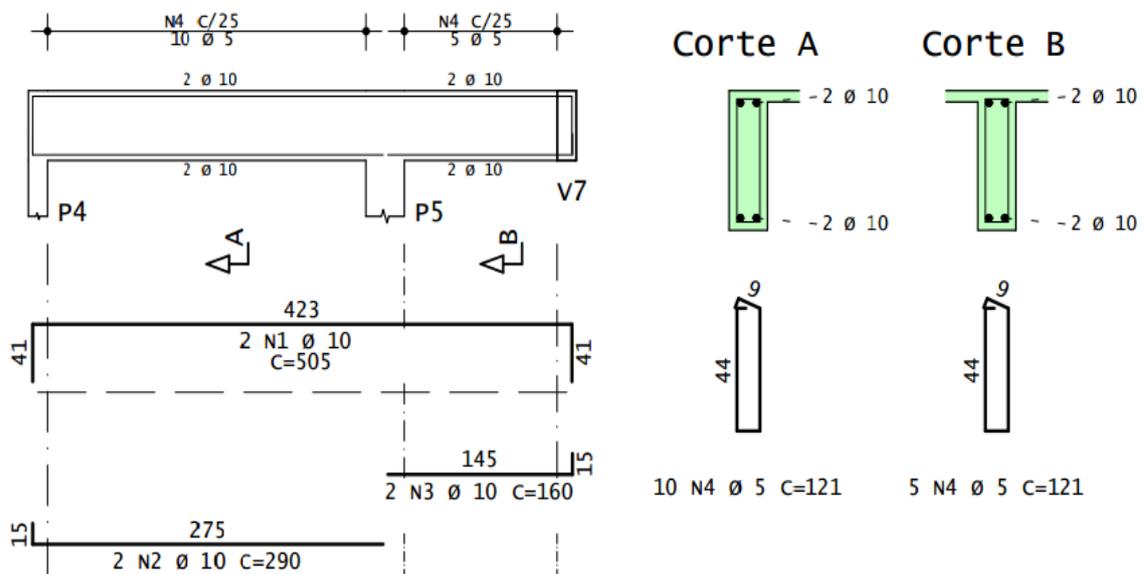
Armadura da viga V6 – coberta (nível +6,00)
